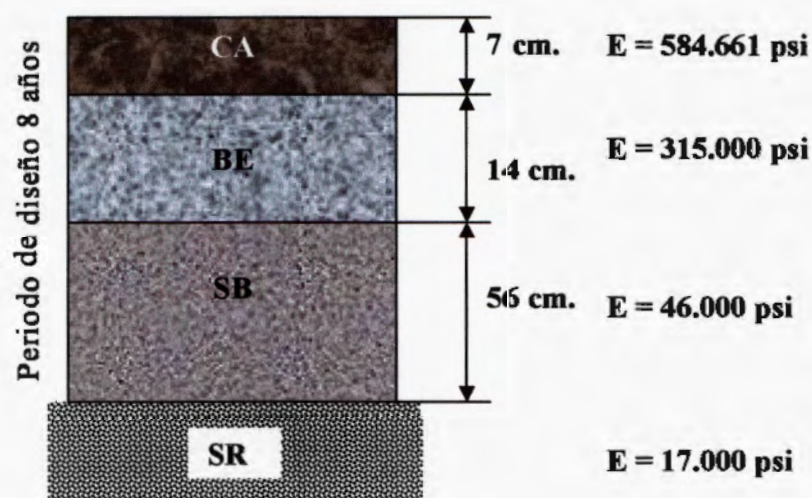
Estructura propuesta del pavimento y módulos de las capas
